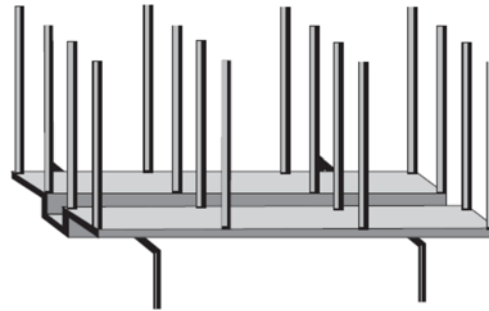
Sistema a piattaforma con pianale ribassato e montanti
